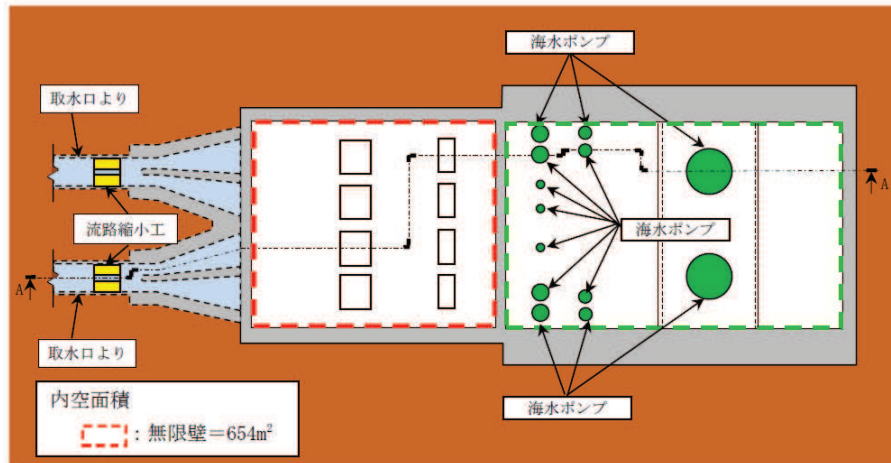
(1) 第 1 号機海水ポンプ室平面図
